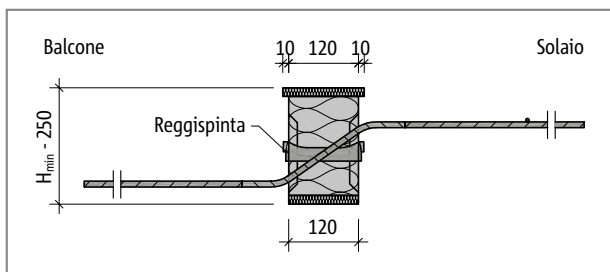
Schöck Isokorb® tipo da QXT60 a QXT90, REI120: sezione dell'elemento
